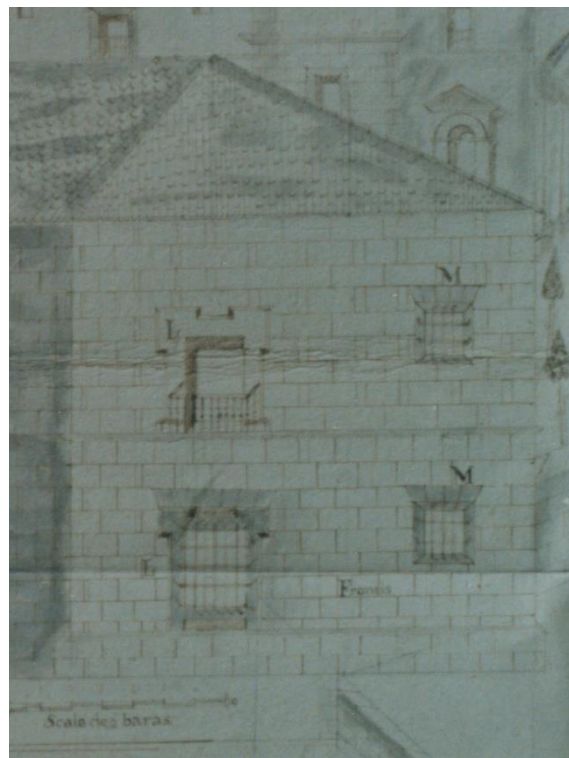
JUAN ANTONIO CAMACHO. *Descripción del plano sexto...* Alzado de la fachada oeste de la enfermería (detalle). Fuente:
